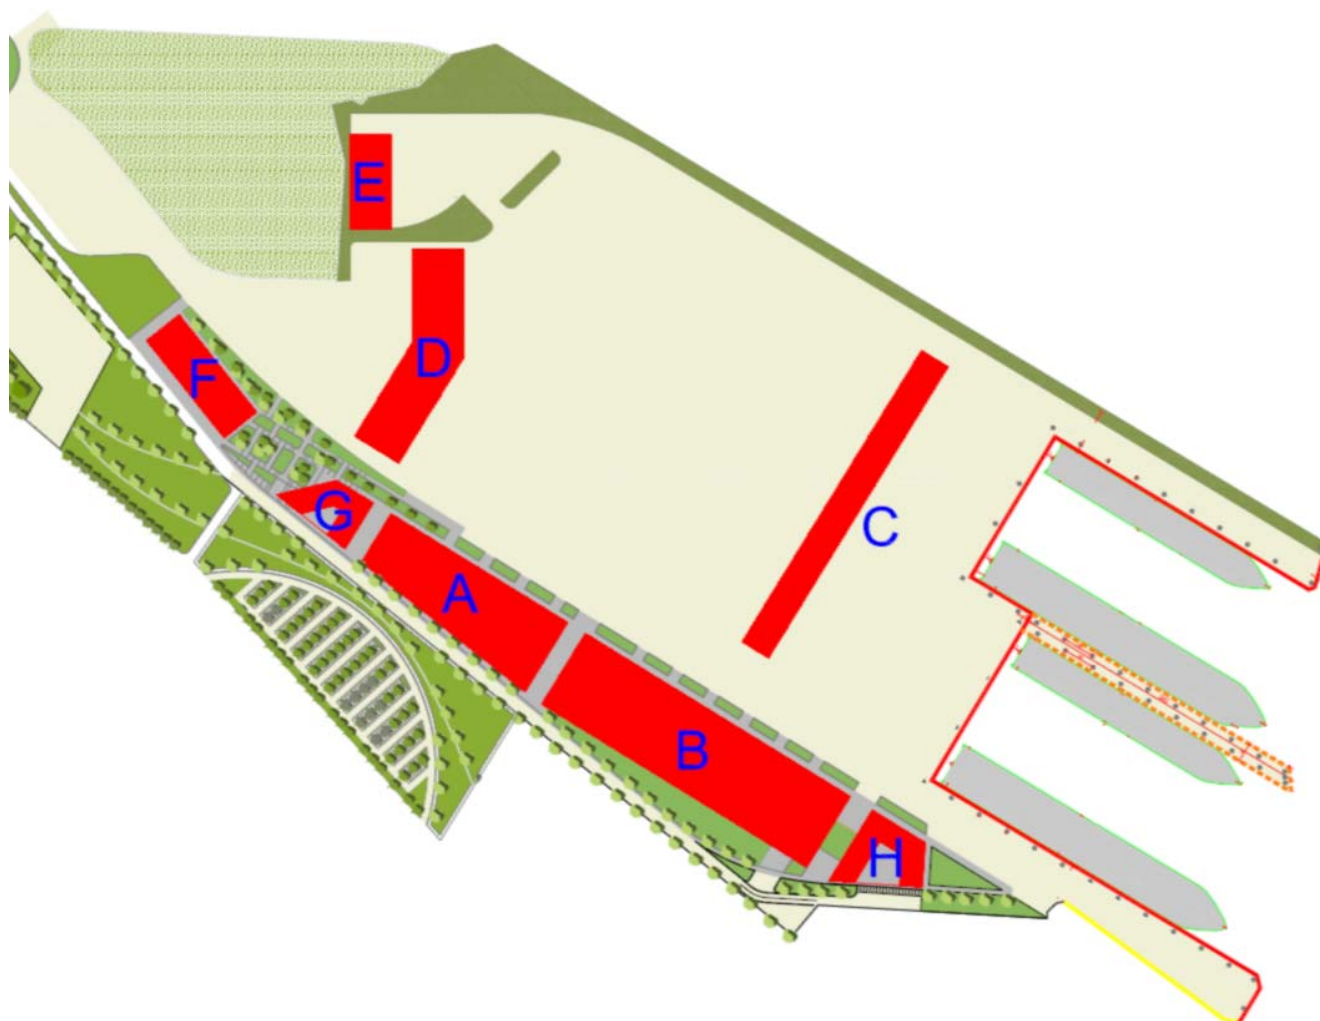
Denominazione convenzionale dei corpi di fabbrica nel layout di progetto.
